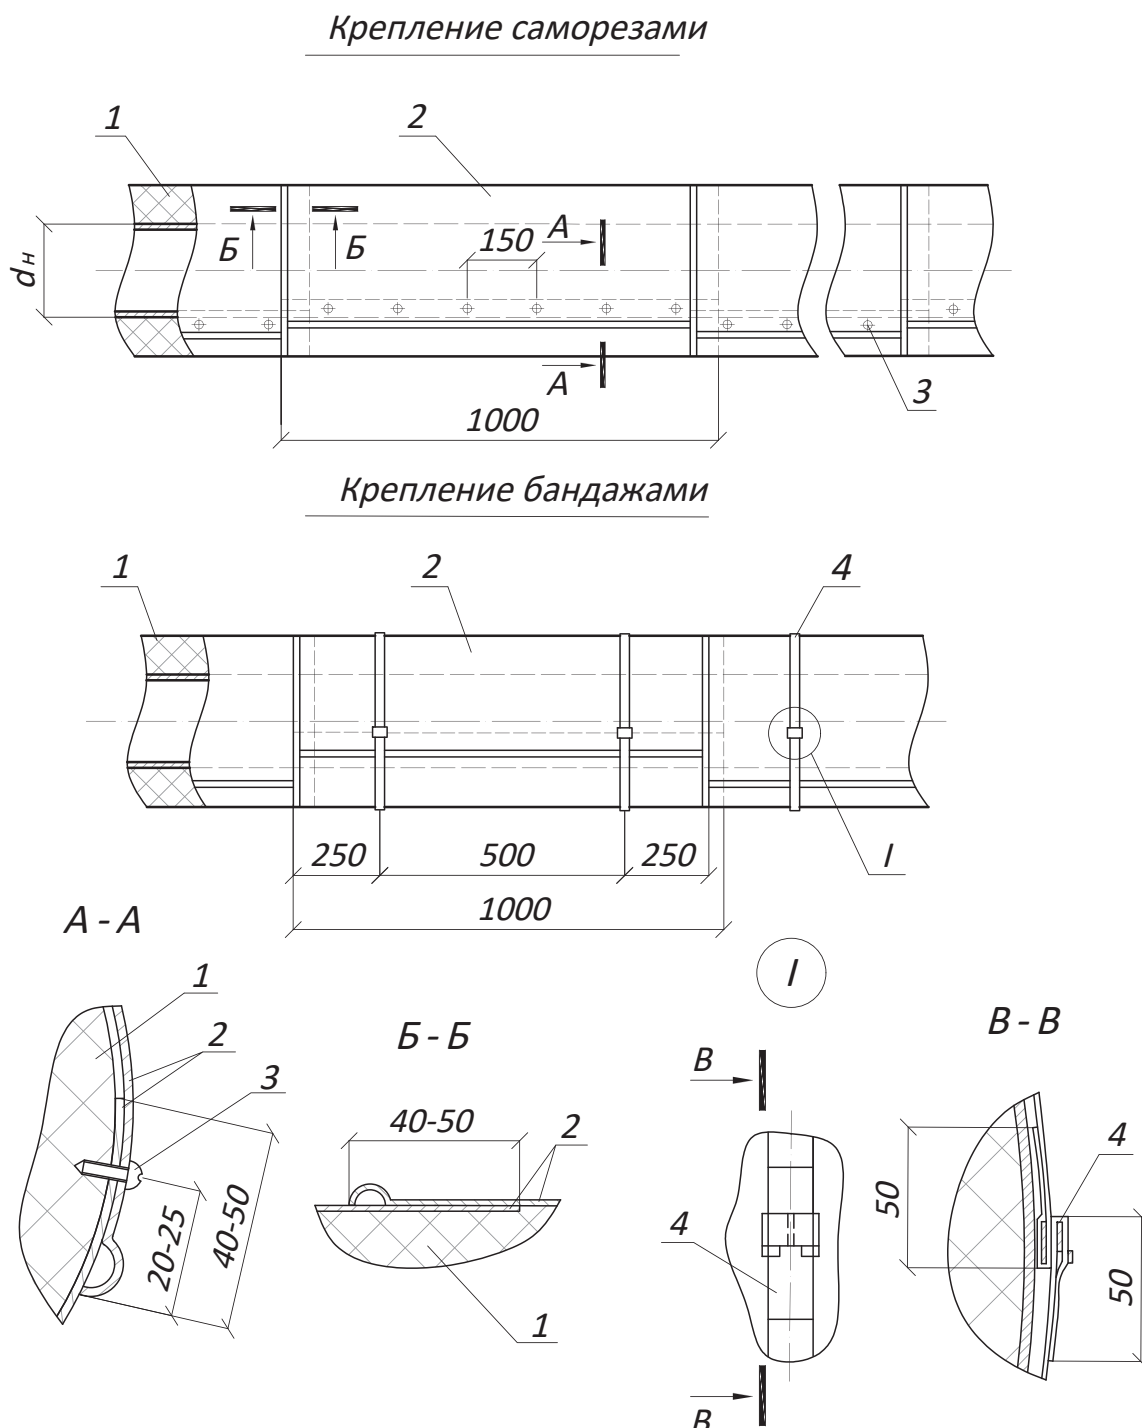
Тепловая изоляция трубопроводов изделиями AEROFLEX с последующей установкой покрытия Aerojacket.
